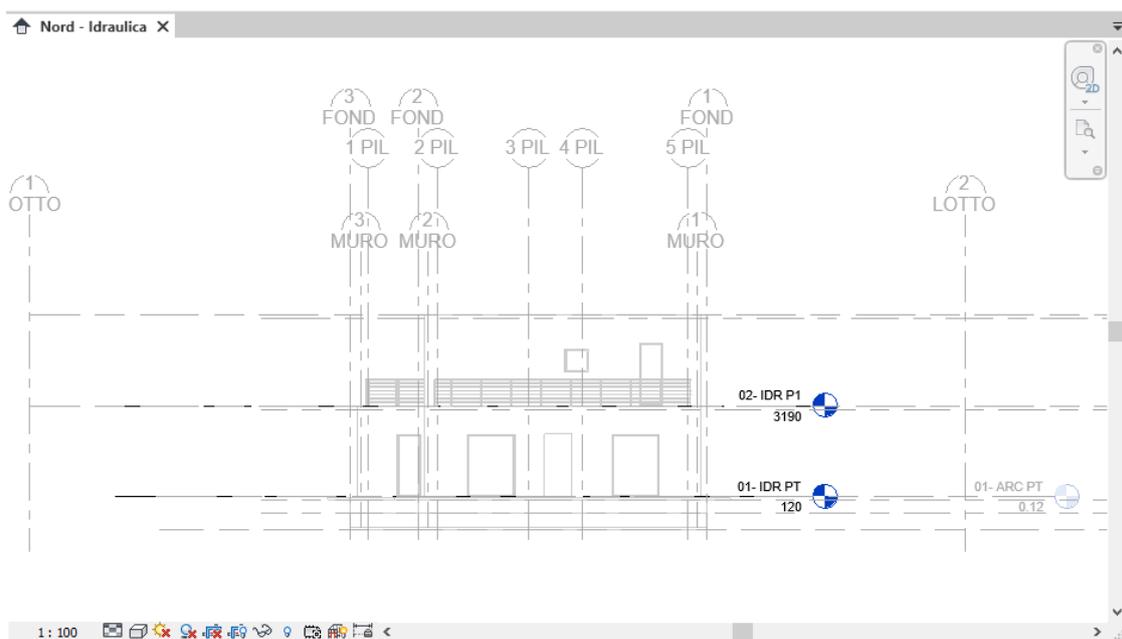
Vista Nord- Idraulica: Prospetto nord modello architettonico e strutturale collegati in mezzi toni
